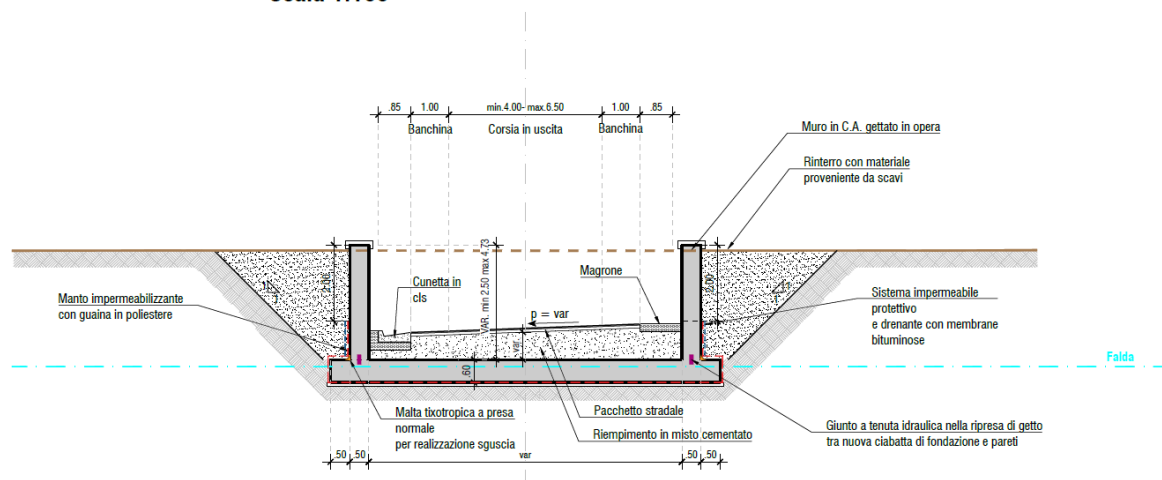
Sezione tipologica muro della rampa 2-E.
